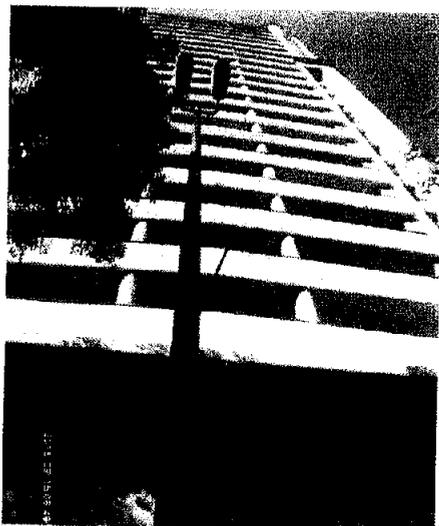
Fachada da Edificação na Av. Afonso Pena 867
